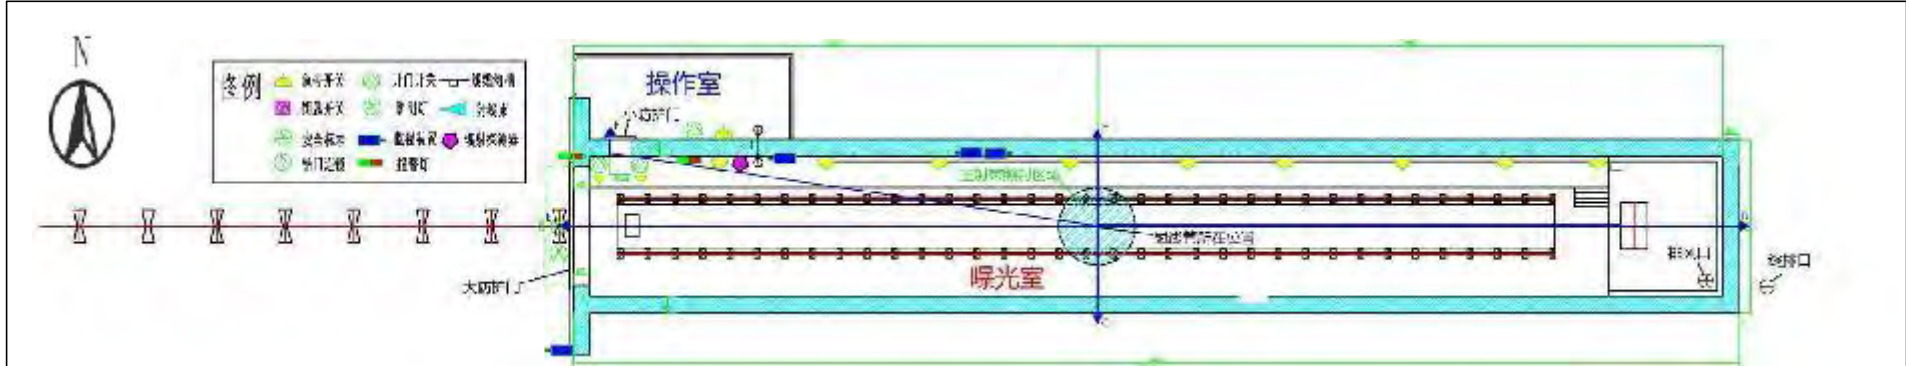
(a) 本项目探伤室平面布置及防护设施布局示意图
